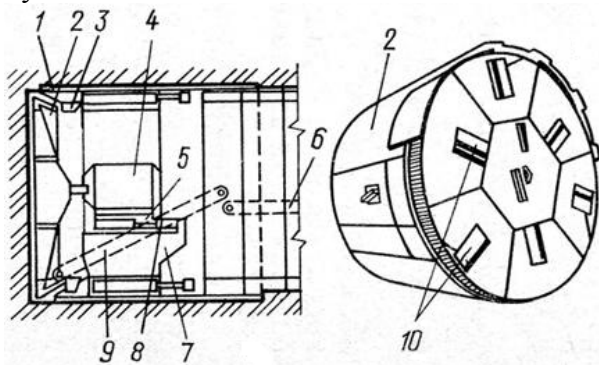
Устройство механизированного щита: 1 — корпус щита; 2 — планшайба; 3 — упорные ролики; 4 — привод; 5 — подвижная станина; 6 — отвальный мост; 7 — неподвижная станина; 8 — домкрат подачи; 9 — транспортер; 10 — резцовые окна.
